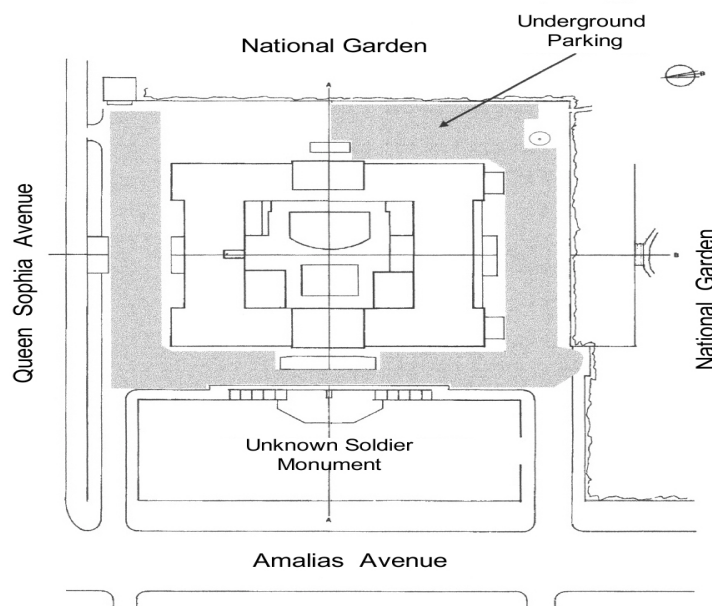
Vista em planta da localização do Parlamento Helénico e do parque automóvel subterrâneo (Leonidou et al, 2001)
